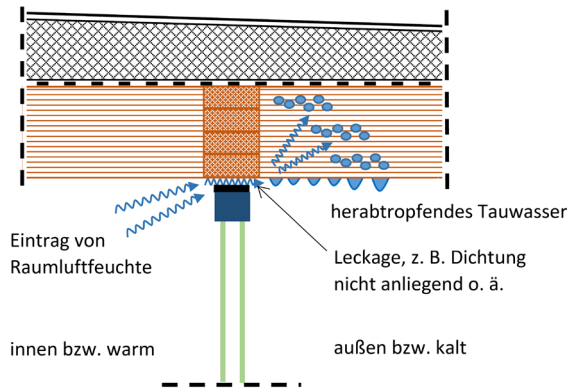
Tauwasserproblematik nach Leckagen in Fassadenanschlüssen
